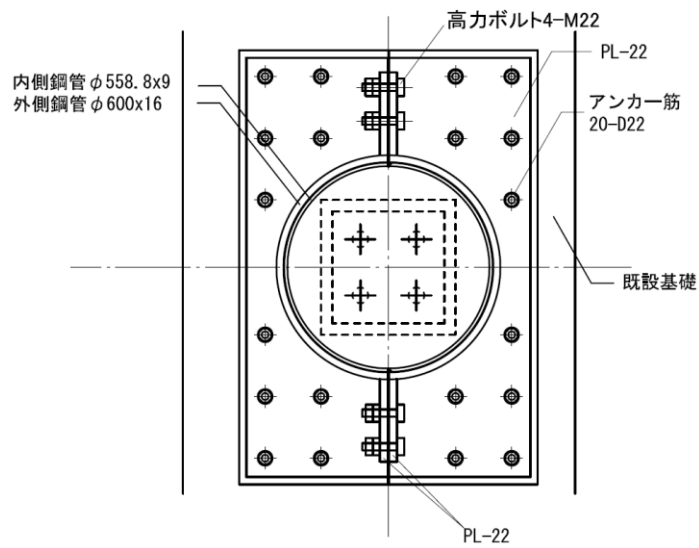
補強鋼管とあと施工アンカー詳細 (伏図)
